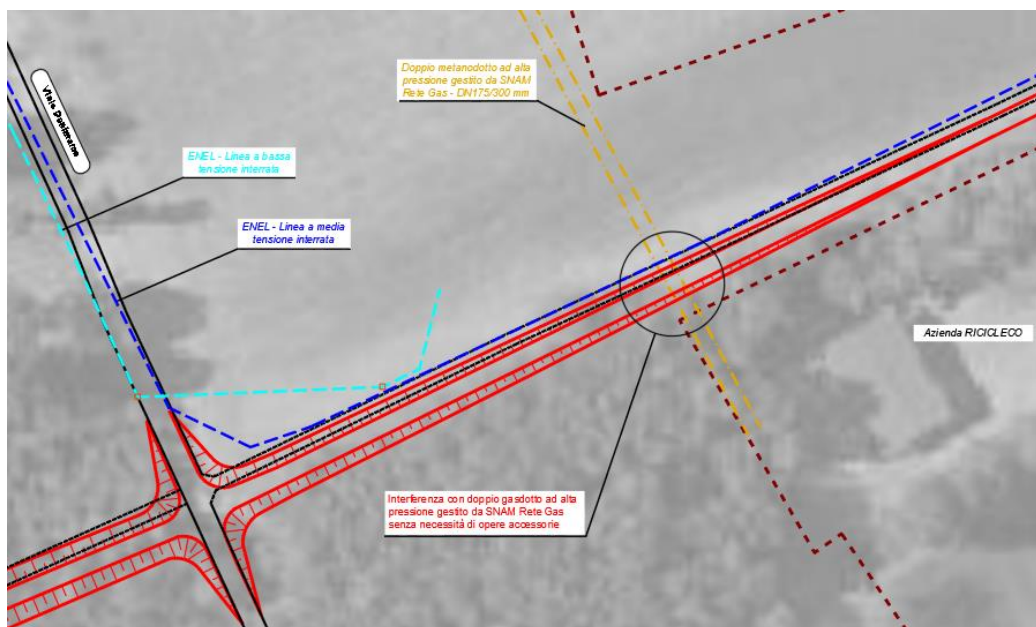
UBICAZIONE DELLA LINEA ELETTRICA A BT (CIANO) E MT (BLU) RISPETTO ALLE OPERE IN PROGETTO
